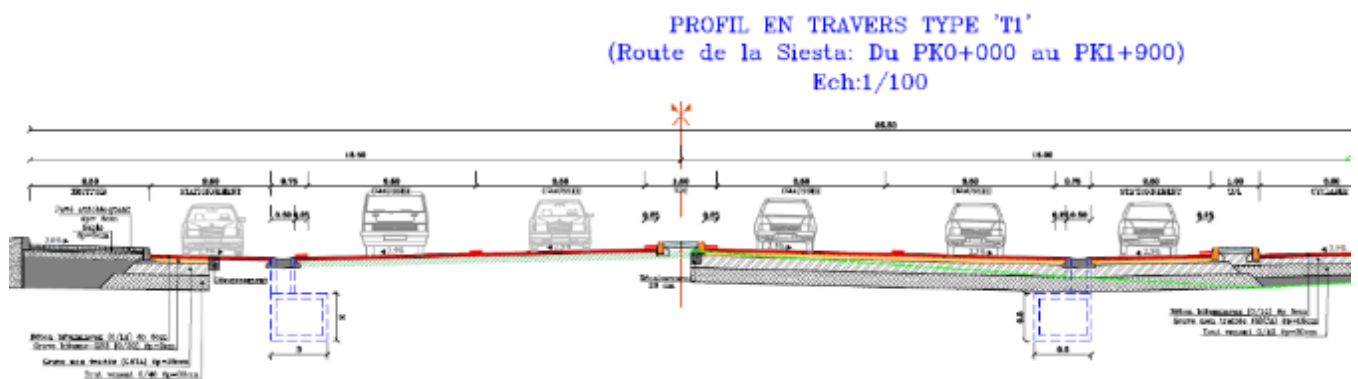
profil en travers Type « T1 » route siesta (Source : APS de l'étude 2024-2025)
